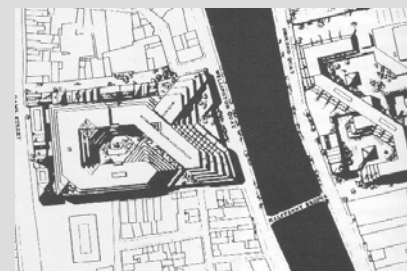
Plan du projet de Gare Centrale, Dublin
